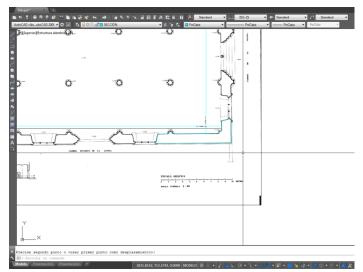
LEVANTAMIENTO MANUAL. Vista general de la esquina sureste del salón columnario, de los planos facilitados por el profesor D. Juan Gómis Gómez-Ygual. Imagen propia.
